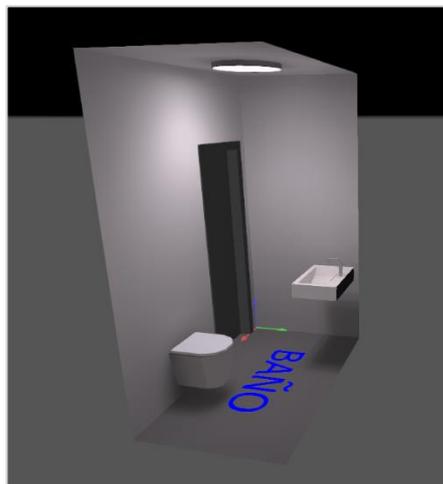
Situación luminarias del baño de la planta baja (fuente propia).
